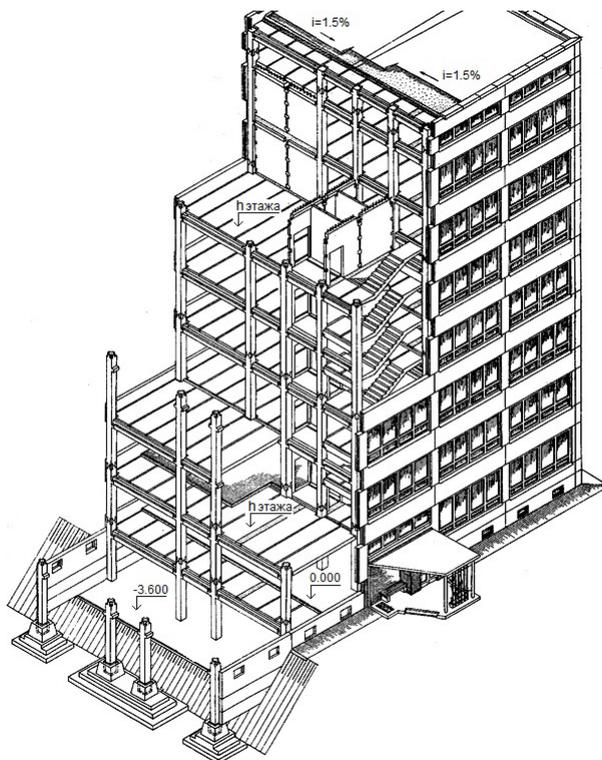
Многоэтажное каркасно-панельное здание из сборных железобетонных изделий серии 1.020-1
